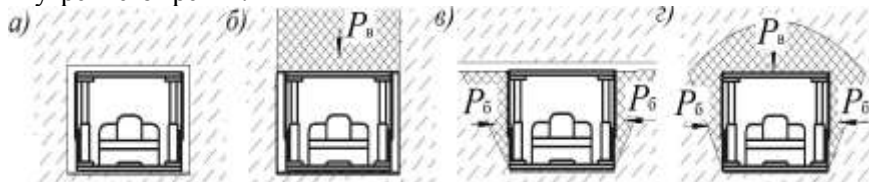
Варианты нагружения проходческого комплекса: а – отсутствие внешних нагрузок на перекрытия крепи комплекса; б – нагружение со стороны кровли выработки; в – нагружение со стороны боков выработки; г – нагружение со стороны кровли и боков выработки
